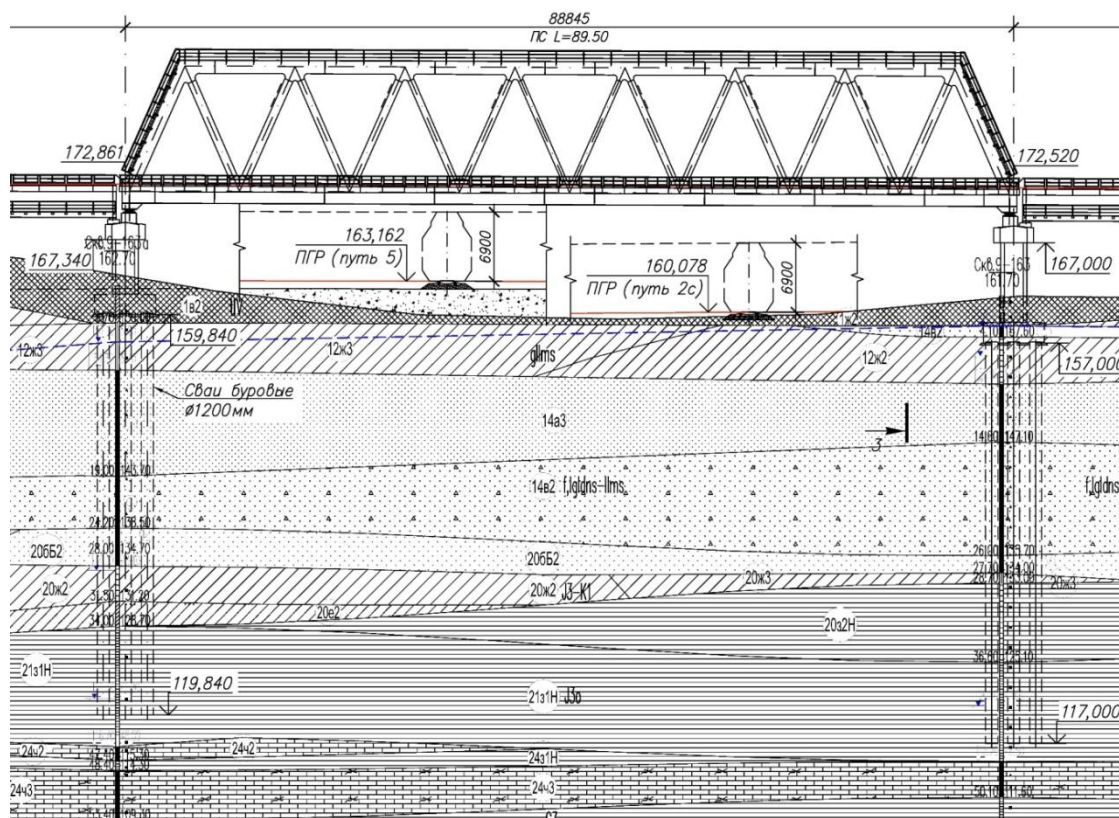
Врезка фундаментов наиболее нагруженных опор путепровода (№ 17, 18) в инженерную геологию
